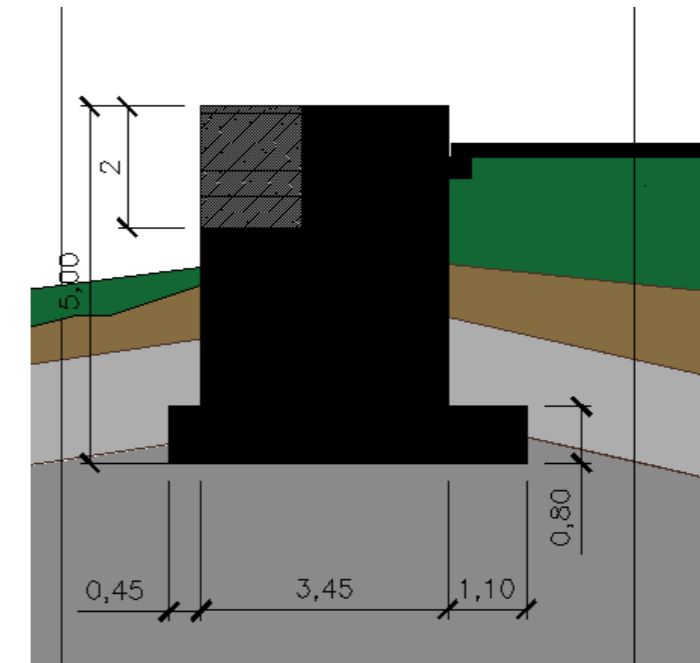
Diseño del estribo en el emplazamiento. Fuente: Elaboración propia.
